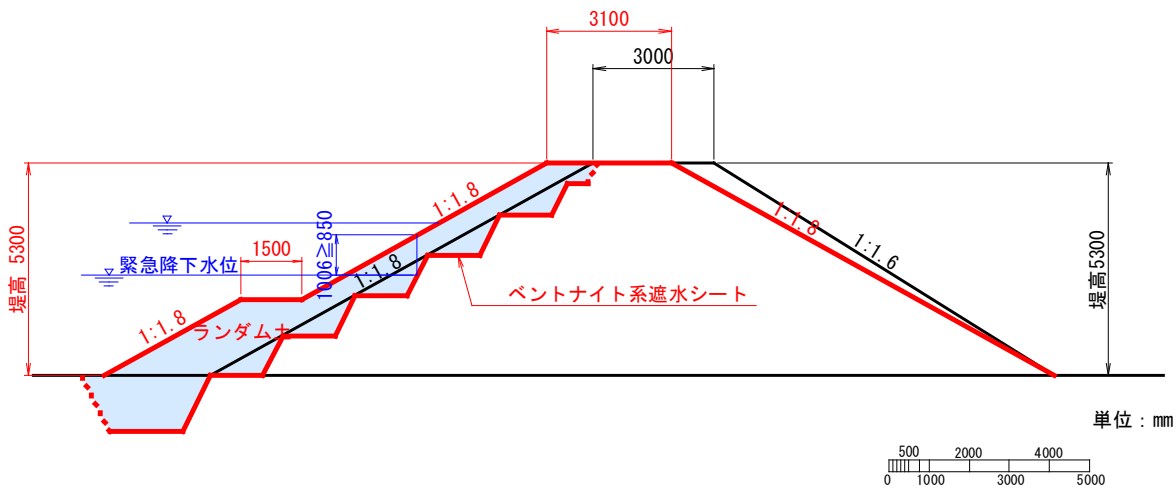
施工コスト算定用計画堤体断面（ベントナイトシート工法）-1（H=5.3 m）
